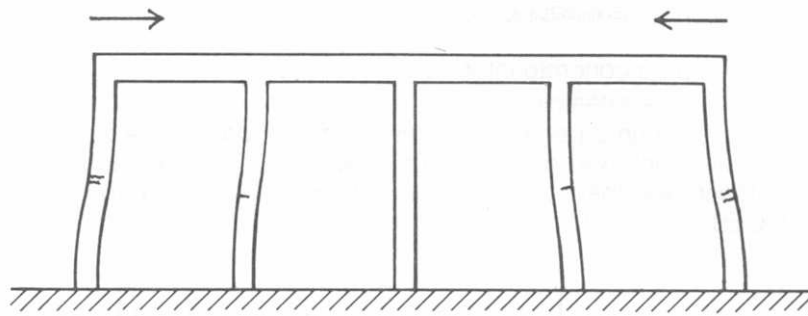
Fissuras horizontais nos pilares, devidas à retração do concreto das vigas superiores.
